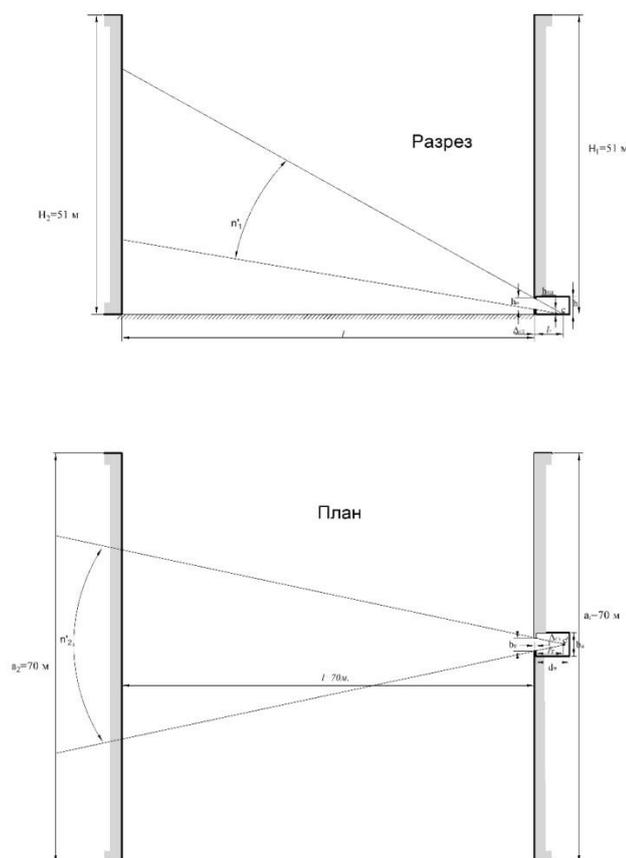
Разрез и план с видимыми из расчетной точки помещения участков фасада противостоящего здания
